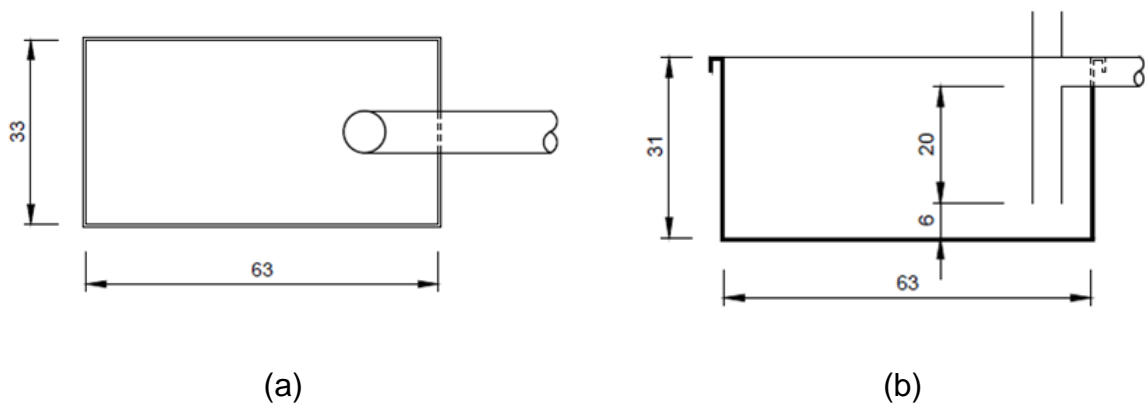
Dimensões da caixa C2: a) Planta e b) Corte.
